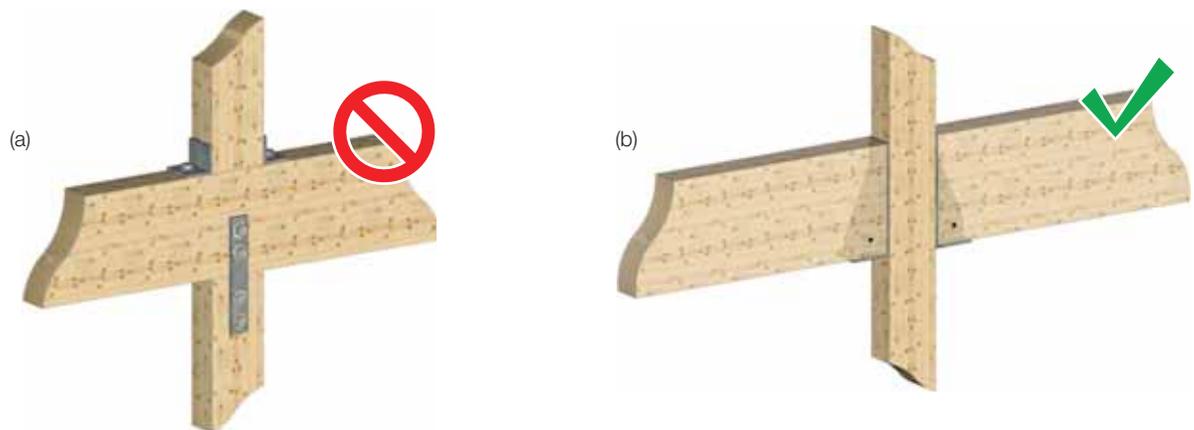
• Assemblage d'une poutre secondaire sur une poutre principale
